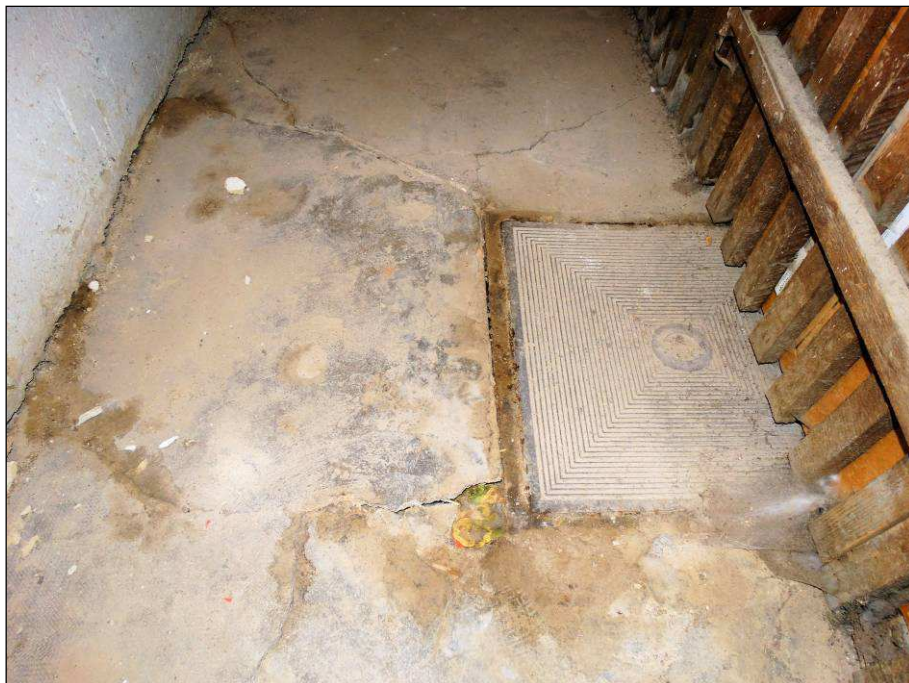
Prosednutá a popraskaná podlaha kolem revizní šachty.
